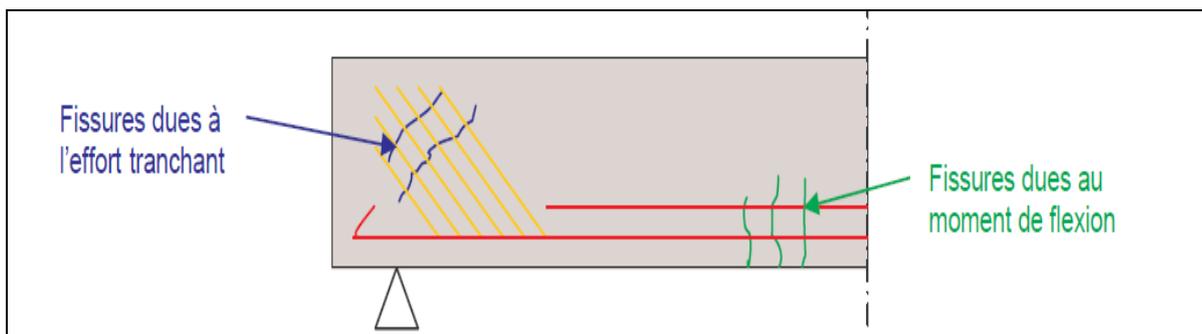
les fissures potentielles dans l'élément en béton
